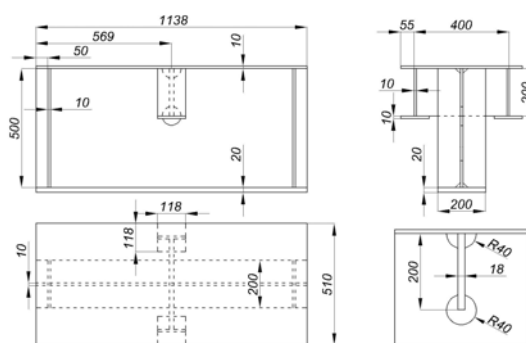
Вид испытуемого образца сварного узла ортотропной плиты
